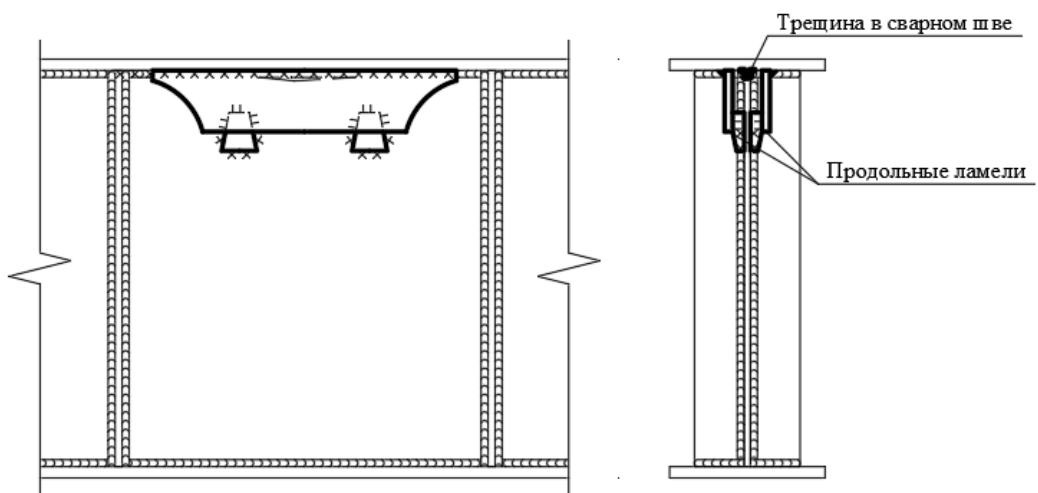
Конструктивное торможение развития усталостных трещин в стенке с установкой: продольных ламелей и элементов, связывающих ламели со стенкой
